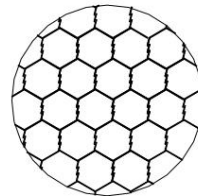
Esquema de alambre galvanizado recubierto en PVC (Maccaferri, 1995).
